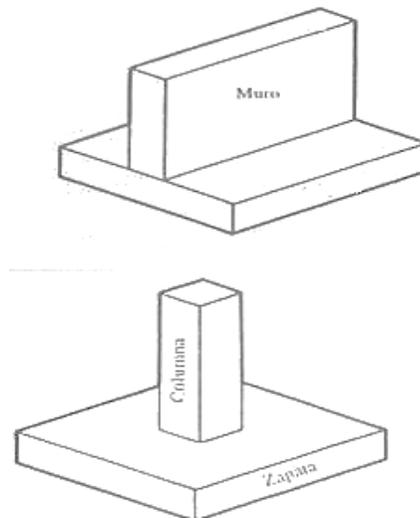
Arriba, ejemplo de cimiento corrido. Abajo ejemplo de zapata aislada
